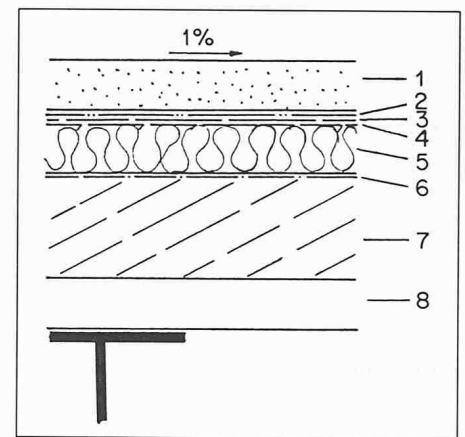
Aufbau der Dachhaut. 1. 50 mm Überzug, 2. PVC-Schutzfolie, 3. Filz 380 g/m², 4. Sarna-Membrane, 5. 50 mm PU-Platten, 6. Dampfsperre, 7. 100 mm armierter Beton, 8. 50 mm Profilblech
